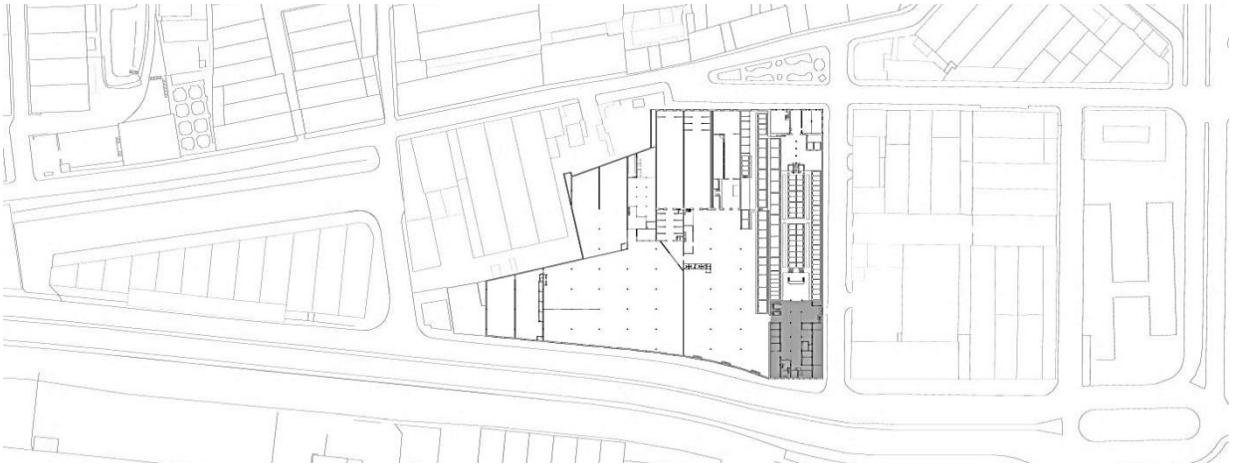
Planta de levantamento fotográfico piso térreo – Armazém 3.
